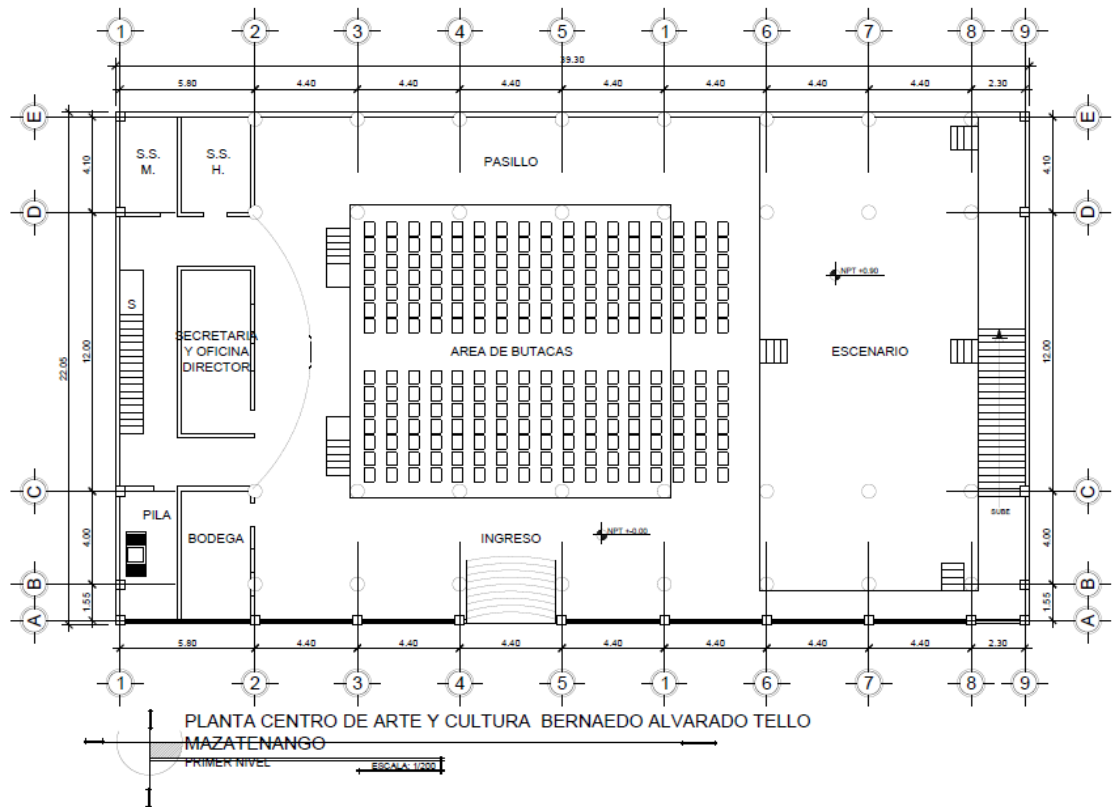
, Planta arquitectónica Plaza Centro de Arte y Cultura
